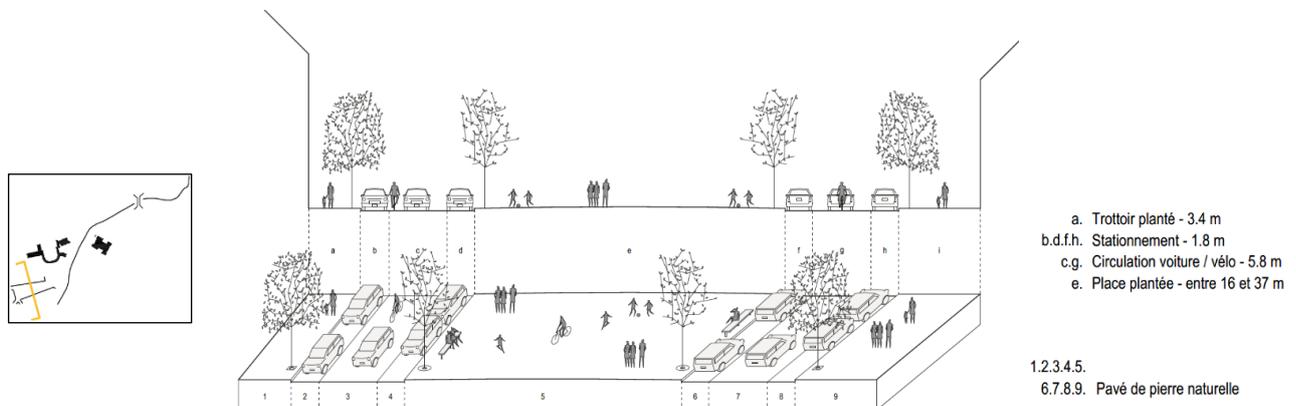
Coupe de la chaussée de Bruxelles à hauteur du liseré commercial (A-Practice, 2018)
